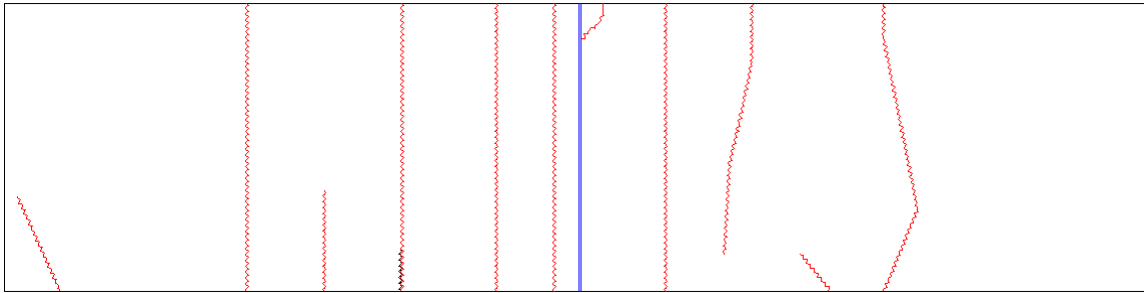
Padrão de fendilhação observado aos 75 dias de ensaio (face inferior).
